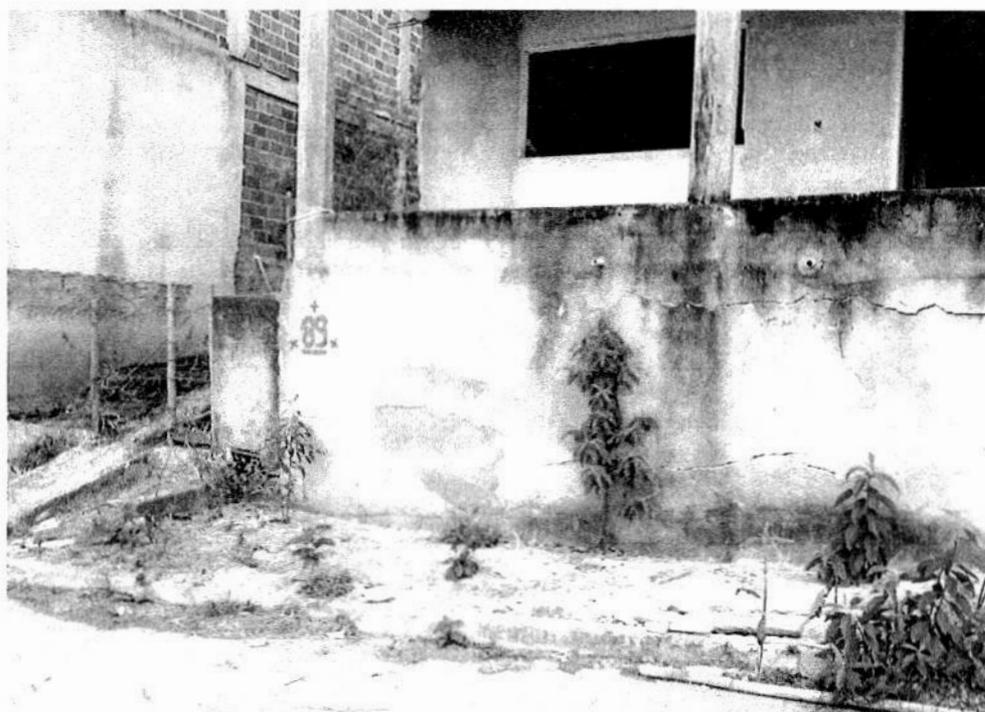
Fachada da casa n° 89 em 23/09/2022
